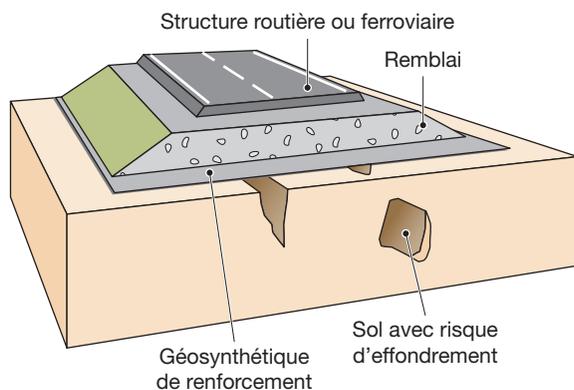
Application d'un géosynthétique de renforcement sur cavités.
